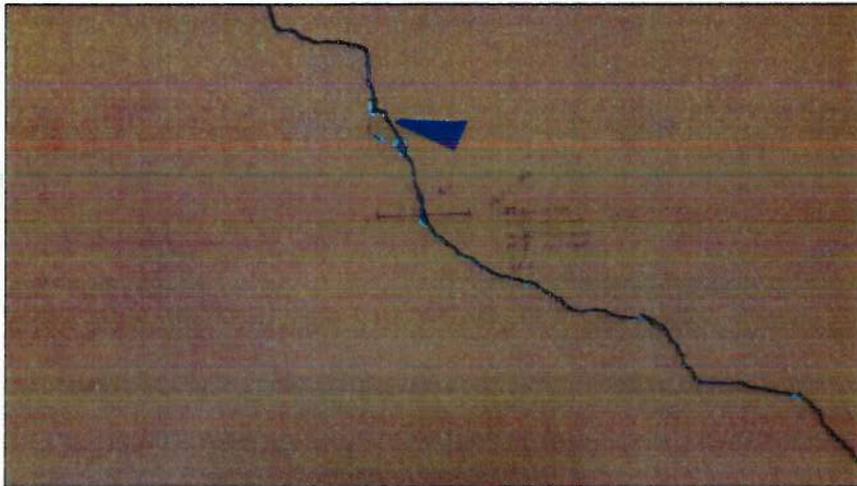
Vivienda OE4-E y S22B fisurada / Ciudadela Solanda
